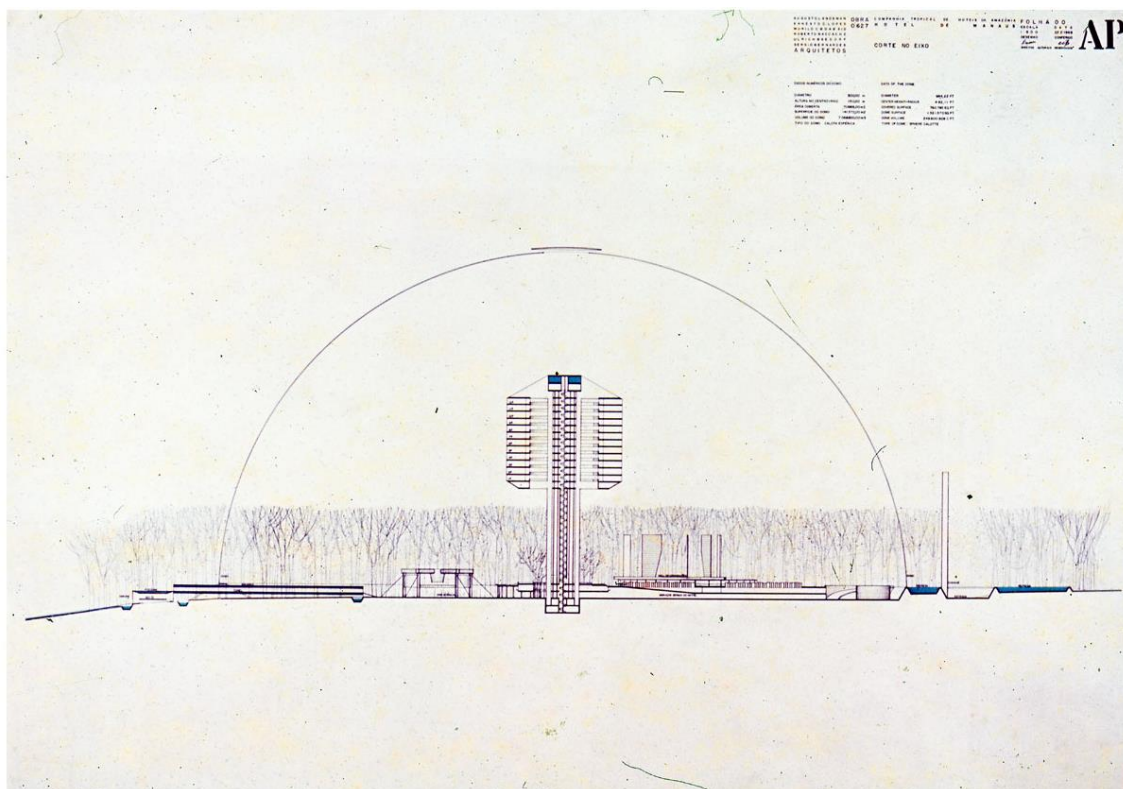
Planta Hotel tropical de Manaus - 1ª versão
